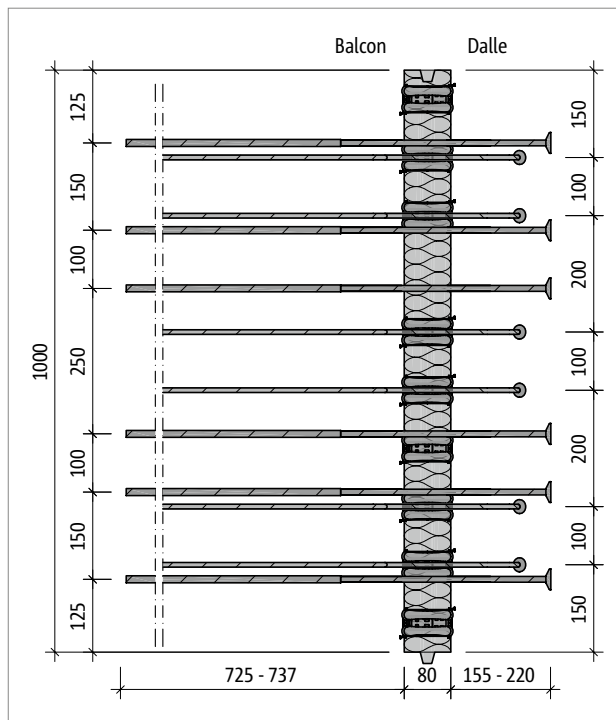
Schöck Isokorb® T type K-U-M2 : plan de base du produit
